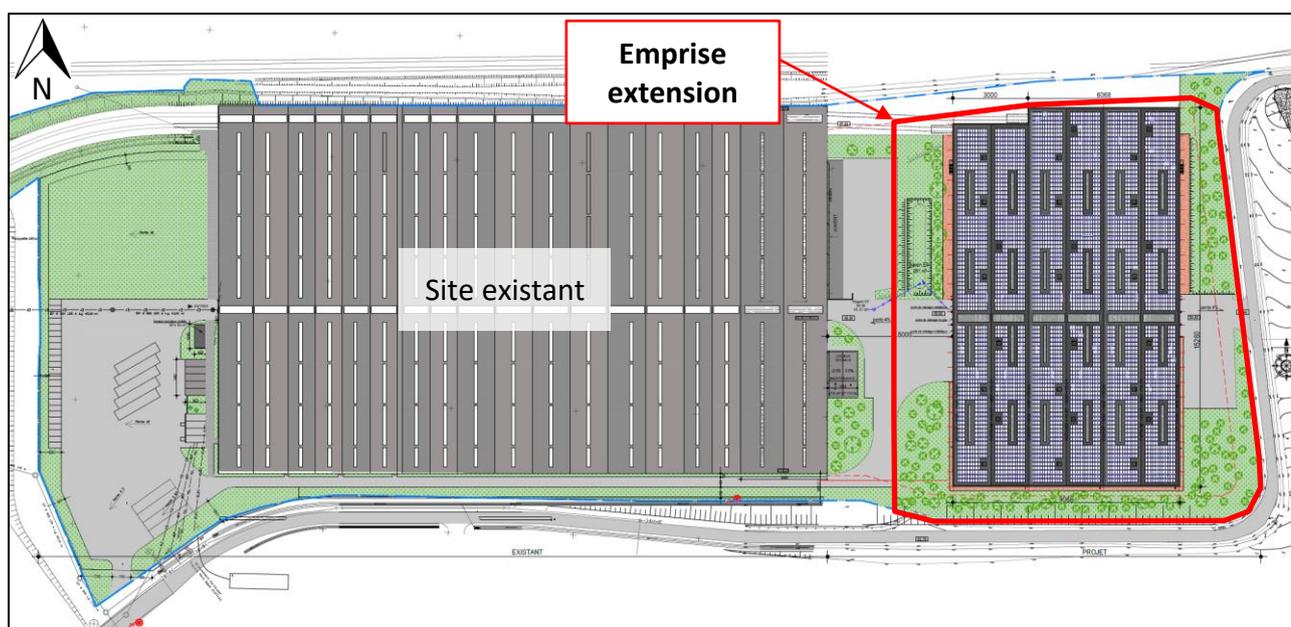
Plan de masse du projet (Source : Interface architecture)
